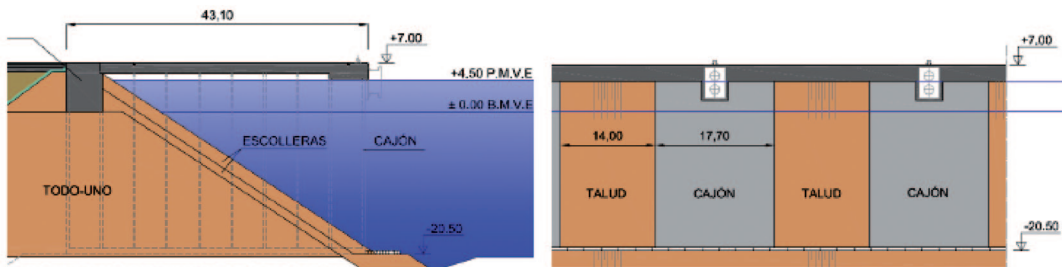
Sección transversal (izda) y alzado (dcha) de la Alternativa 1.
